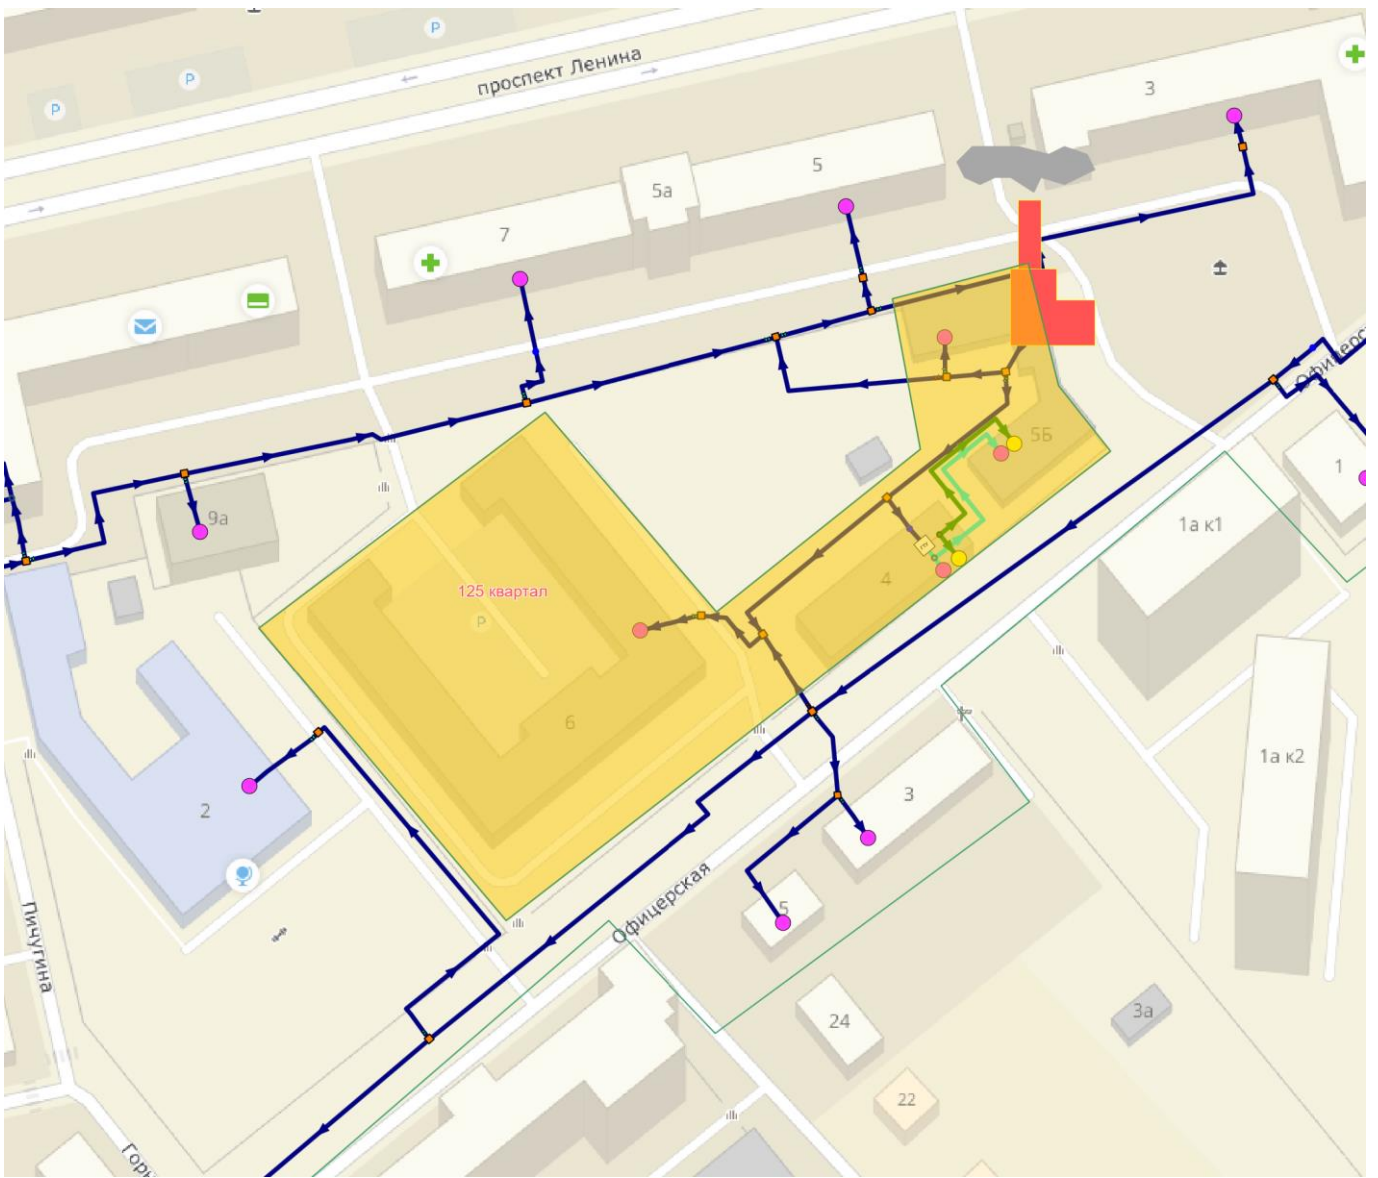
Схема тепловых сетей системы теплоснабжения котельной 125 квартала (ЕТО-1)
